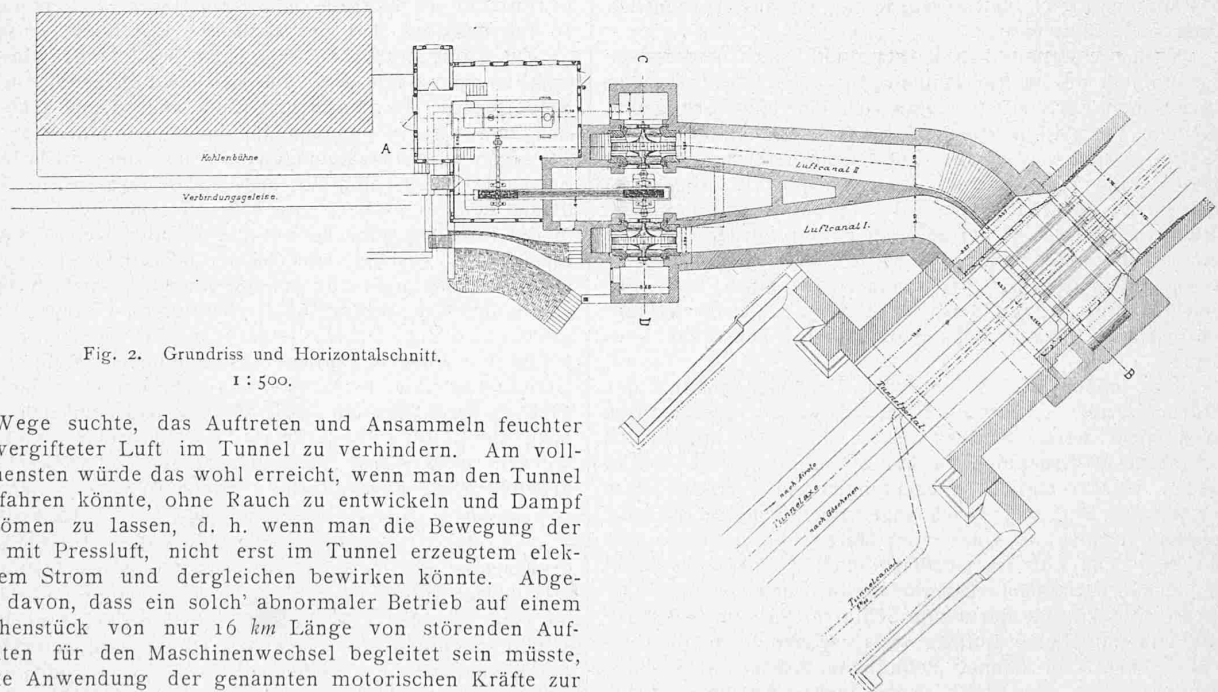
Grundriss und Horizontalschnitt.
